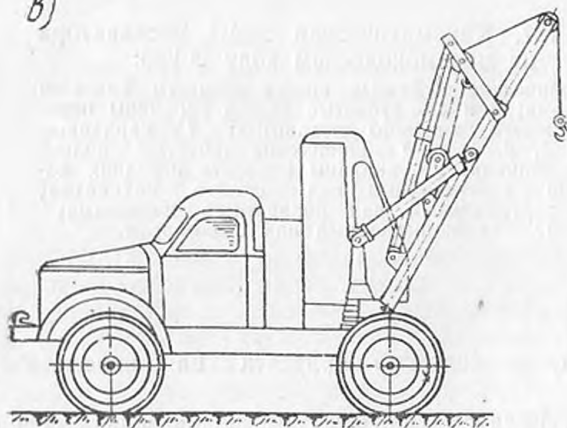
Схема сменного рабочего оборудования экскаватора Э-151:
